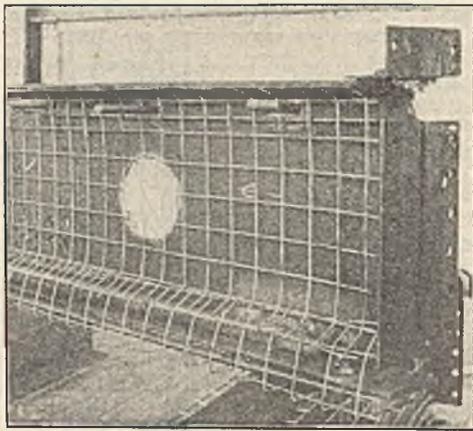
Alter Walzträger mit Verstärkungs-Bewehrung vor dem Torkretieren.
